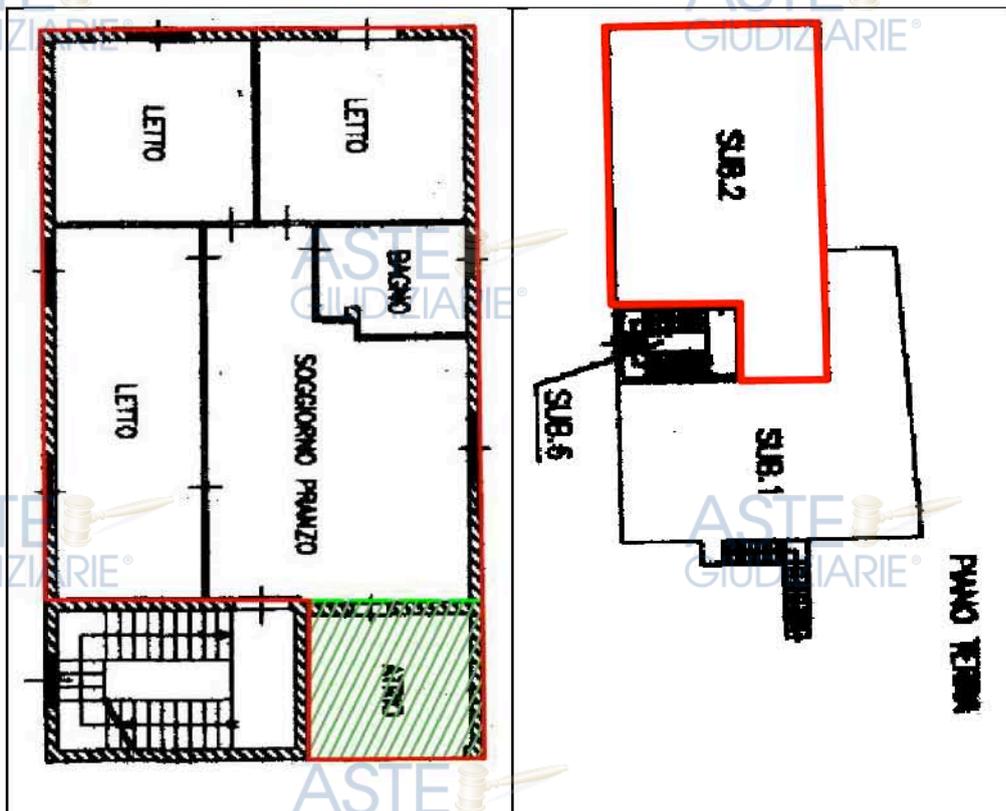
\_ Planimetria del sub.2 allegata all'atto di compravendita (data presentazione 05.03.2001); in rosso consistenza sub. 2 desunta dall'Elaborato Planimetrico; in verde ambiente "Atrio"
